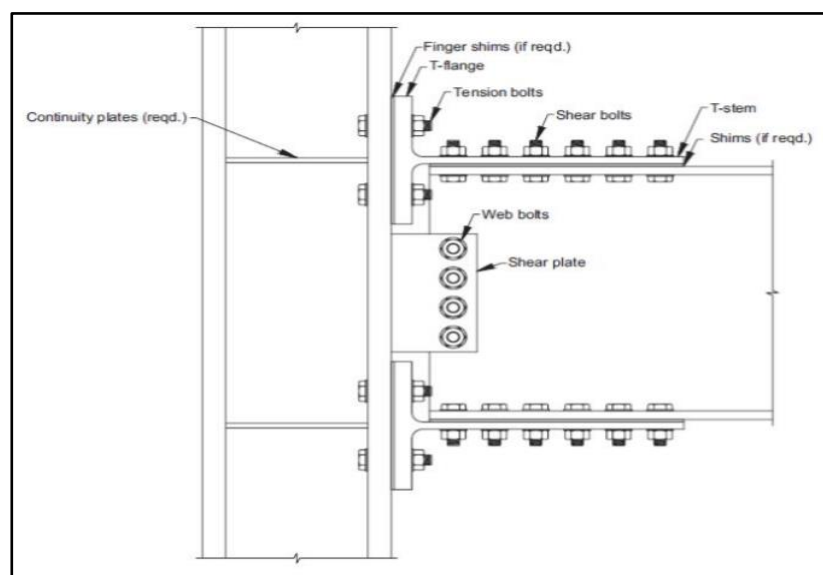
Modelo de conexión DOBLE-TEE. AISC358 (2016)
